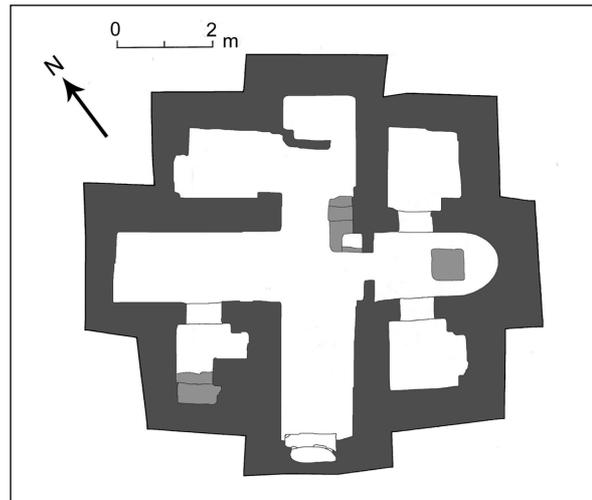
Grundriss der Kirche US022.A (Zeichnung: I. Säuberlich).
